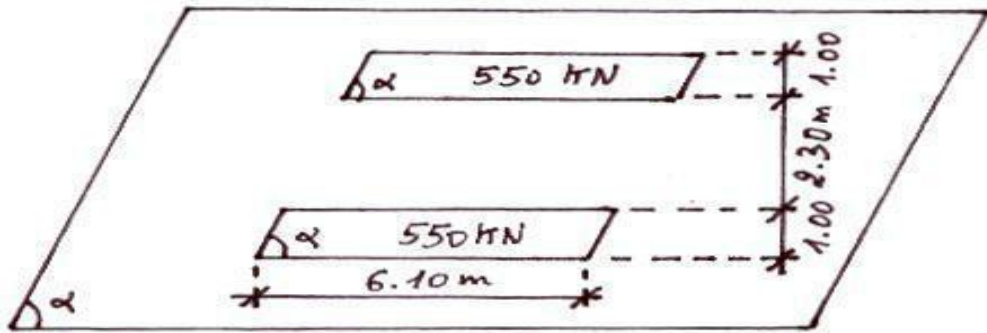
Exemple de disposition en plan d'un véhicule Mc 120 dans un pont biais.
